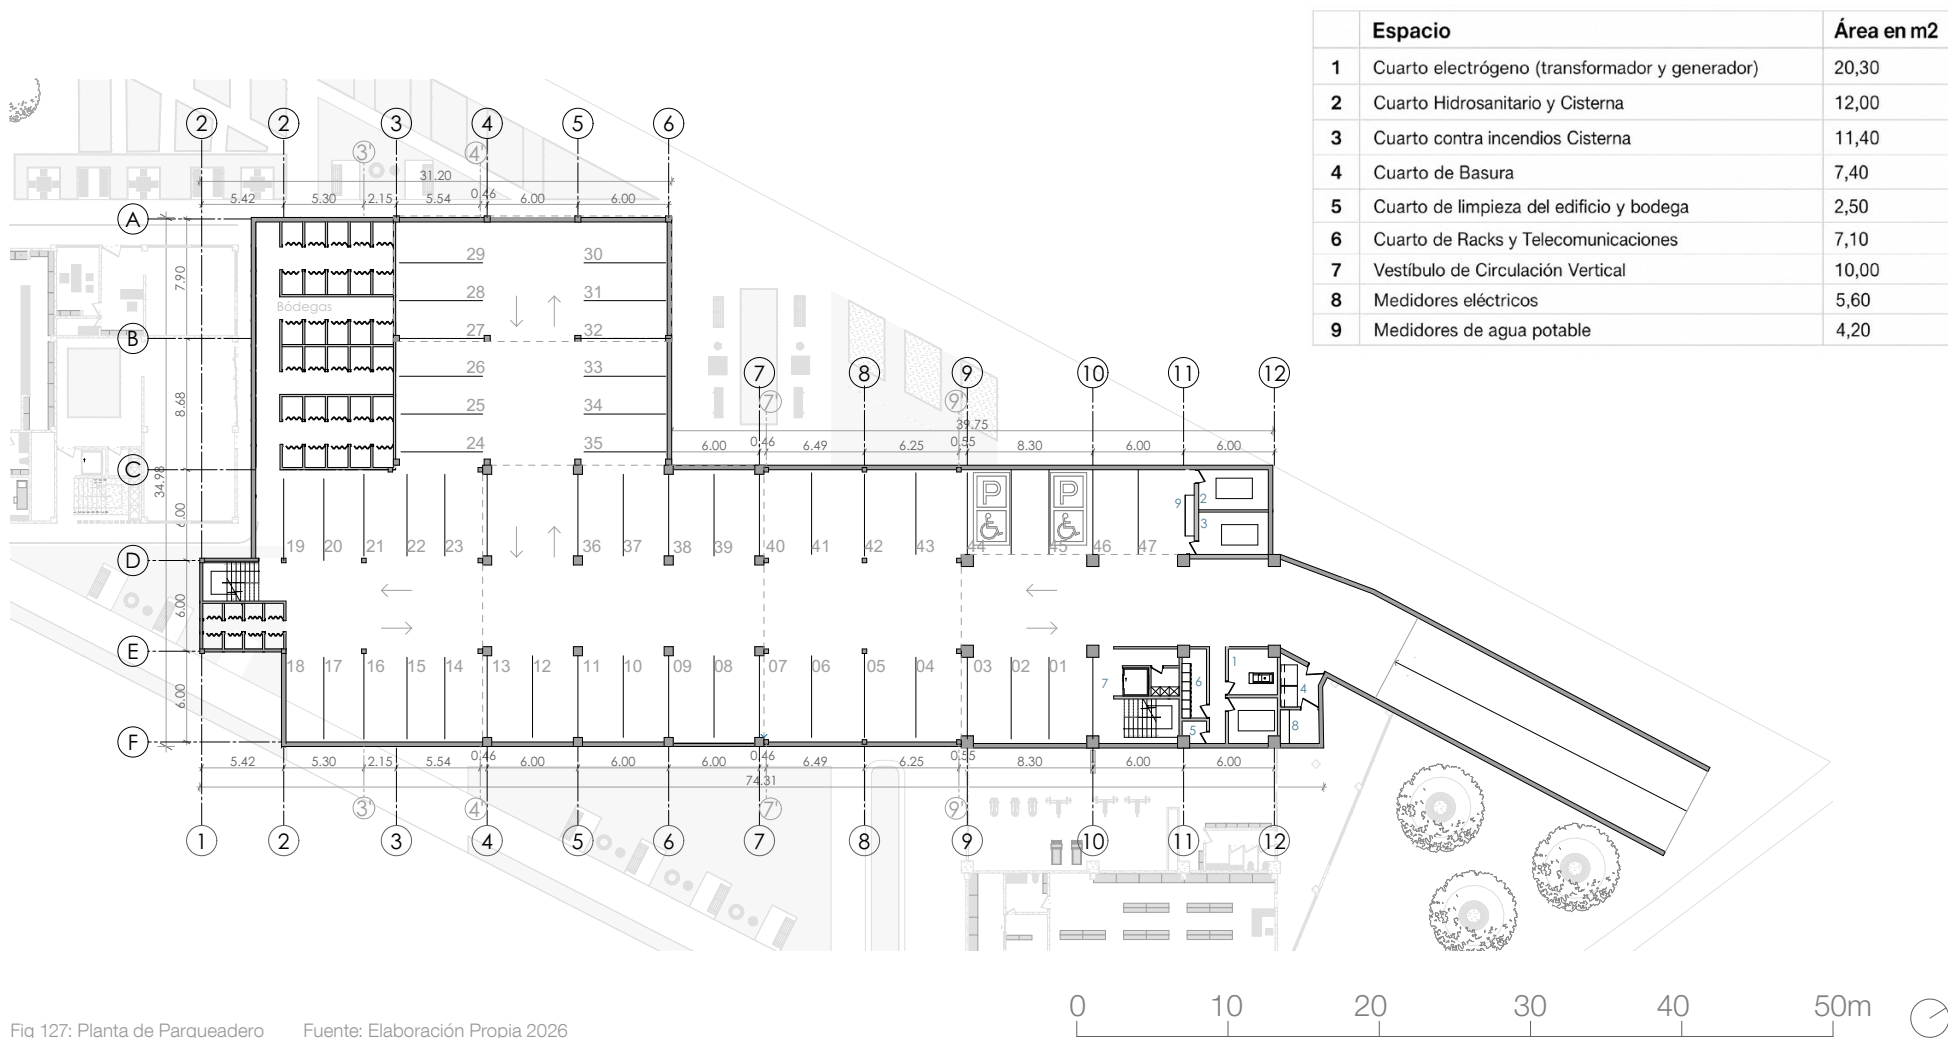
Planta de Parqueadero Fuente: Elaboración Propia 2026
